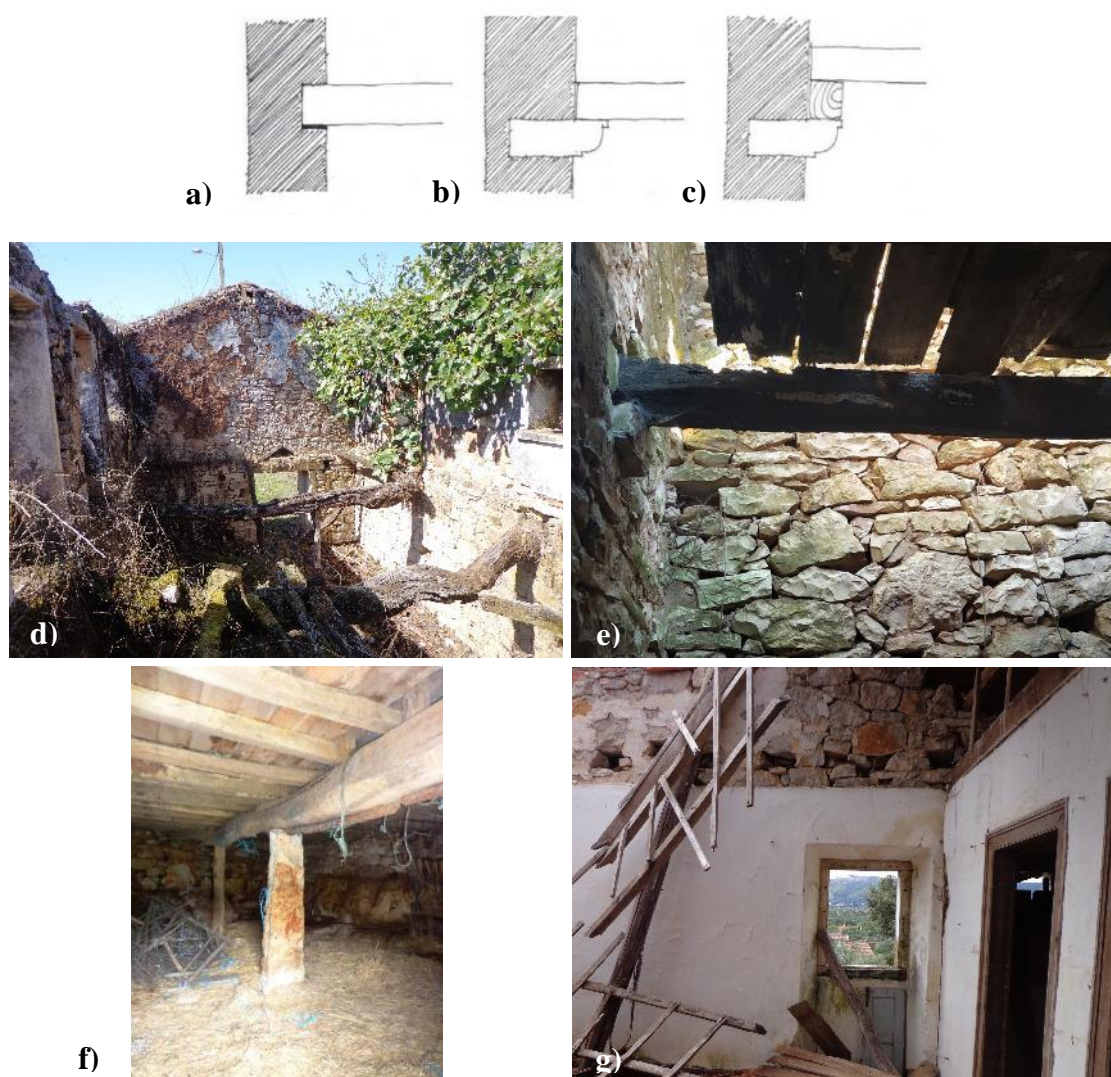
a) Encastramento de viga em parede resistente; b) Apoio de viga em cachorro; c) Apoio de em cachorro de vigamento cruzado; Vigamento tosco de carvalho embutido nas paredes resistentes; b) Vigamento de carvalho apoiado em cachorro; e) Apoio de viga transversal e barrote de suporte de primeiro piso com esteios de pedra; f) Encaixe de vigas em parede resistente em zona de forro
